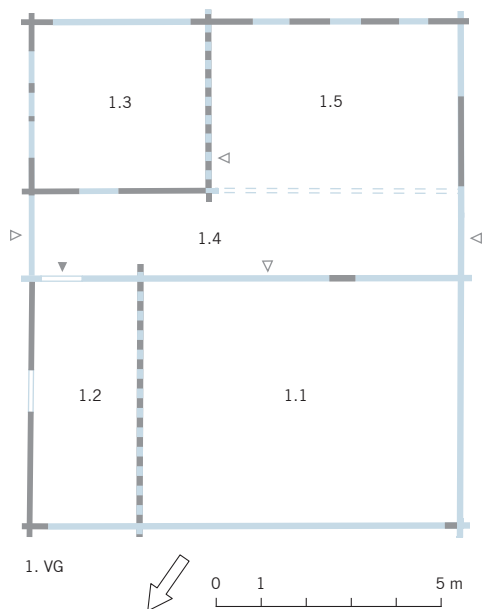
Neudorfstrasse 6 in Menzingen, Grundriss des ersten Vollgeschosses.
